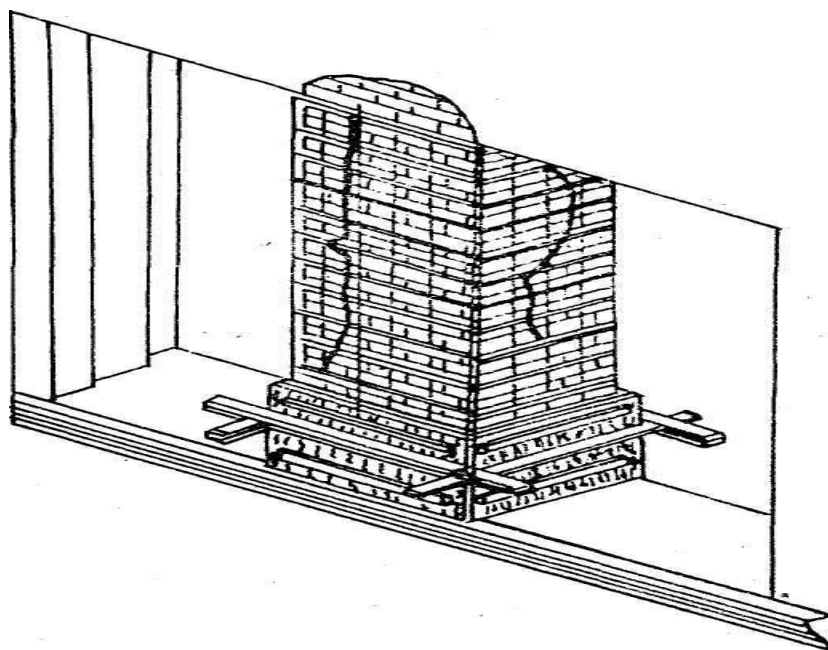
Встановлення опалубки при зміцненні простінка залізобетонною обоймою
